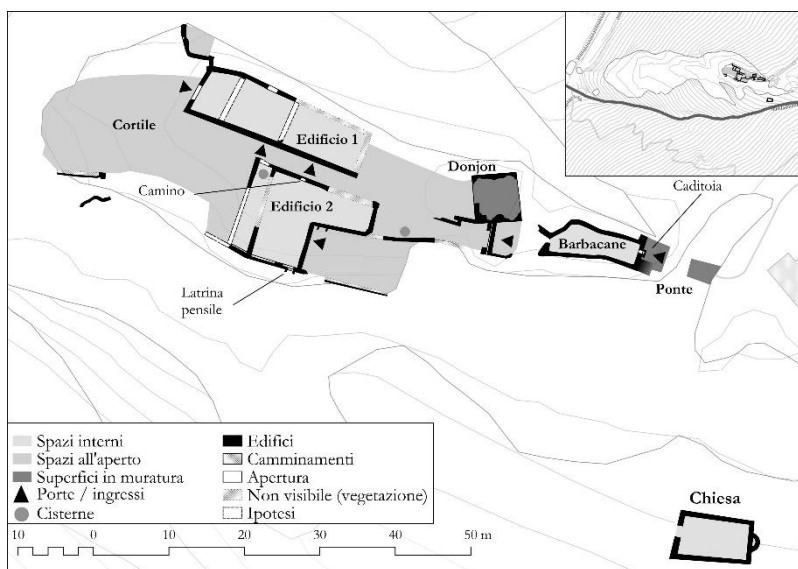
Planimetria del castello di Licusati (D. Sica).
